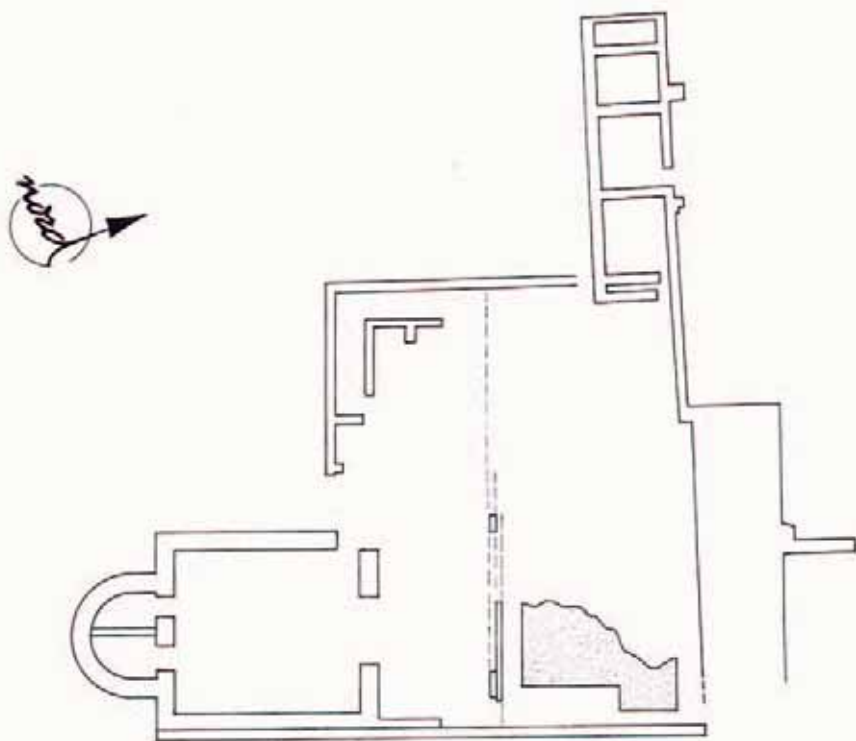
Santuario di Esculapio, fase imperiale (schizzo planimetrico).
